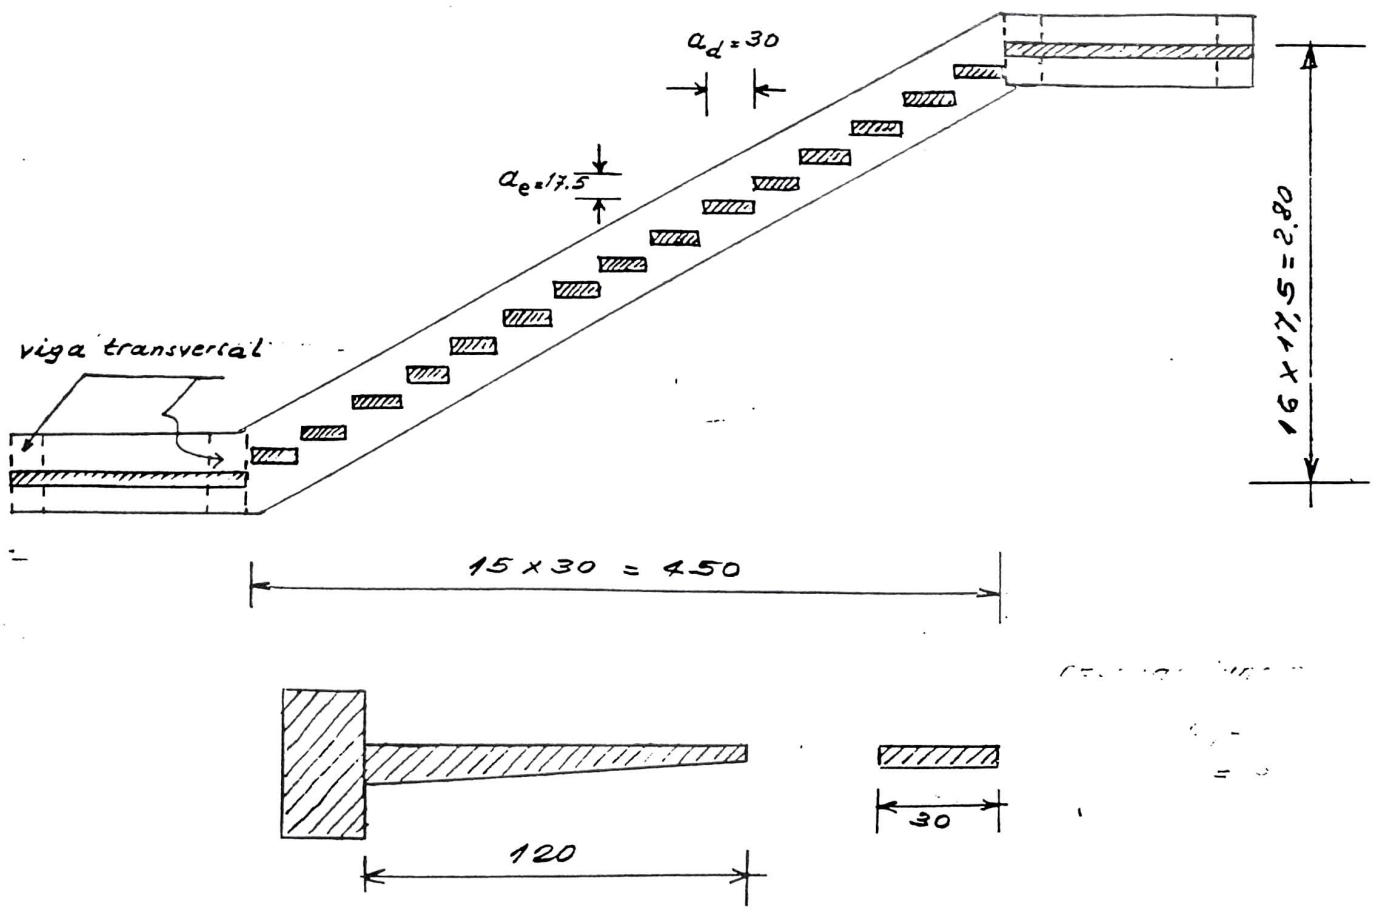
Escada em viga reta com degraus em balanço.
